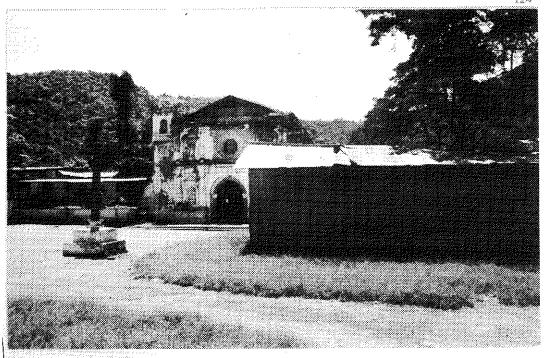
Vista interior de la fachada donde se aprecia el faltante de acabados.
